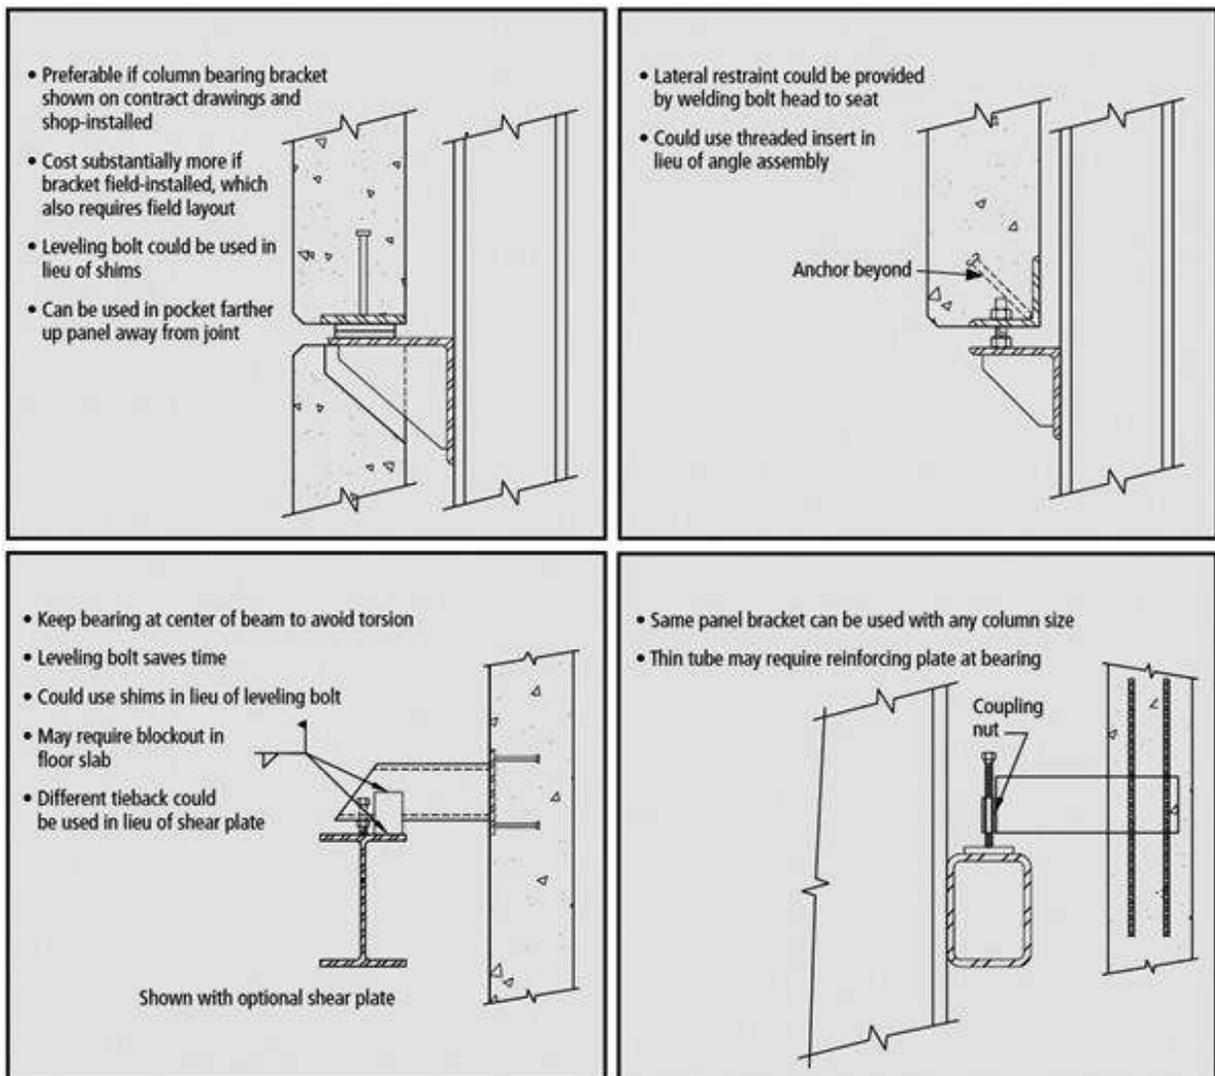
Detalhes das fixações de apoio vertical em estruturas de aço e concreto. No detalhe superior à esquerda é preferível quando as cantoneiras de apoio do pilar são previamente instaladas. Parafusos de nivelamento podem ser usados no lugar dos espaçadores. No detalhe superior à direita, a restrição lateral pode ser obtida soldando-se a cabeça do parafuso à cantoneira inferior. No detalhe inferior à esquerda, o apoio deve ficar bem no eixo da viga para evitar torção na mesma. O parafuso de nivelamento permite precisão e rapidez no ajuste. Uma placa de travamento deve ser soldada para travamento. No detalhe inferior direito, o mesmo tipo de cantoneira pode ser utilizada para qualquer tamanho de pilar. O tubo de apoio pode requerer reforço e funciona como base para o parafuso de ajuste. (PCI, 2007)
